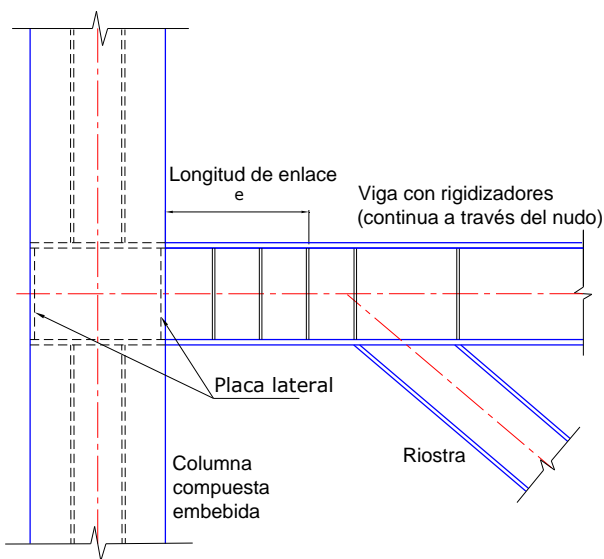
Ejemplo de conexión del enlace de un pórtico compuesto arriostrado excéntricamente.
